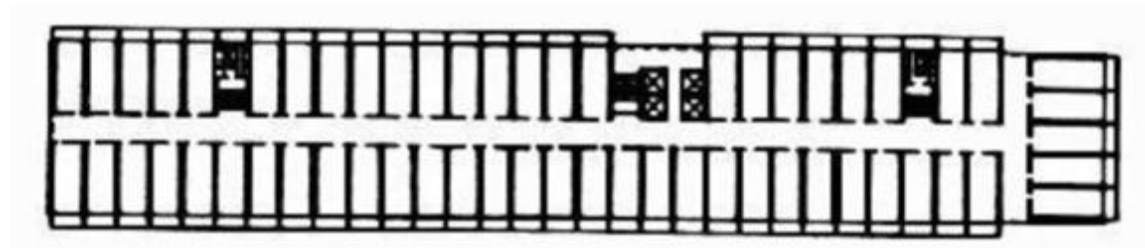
Planta Arquitectónica de la torre. (ArchDaily, s.f.)
